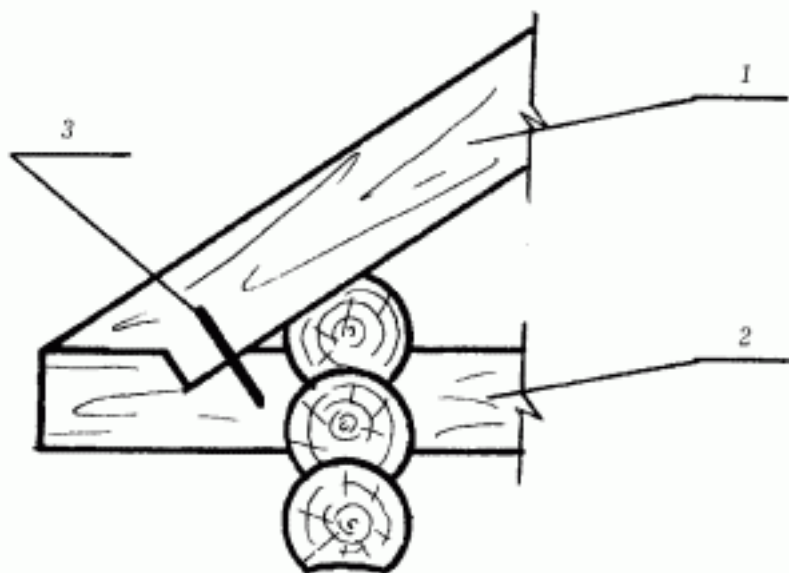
Соединение ригеля и стропильной ноги: 1 – стропильная нога; 2 – ригель; 3 – скоба.
